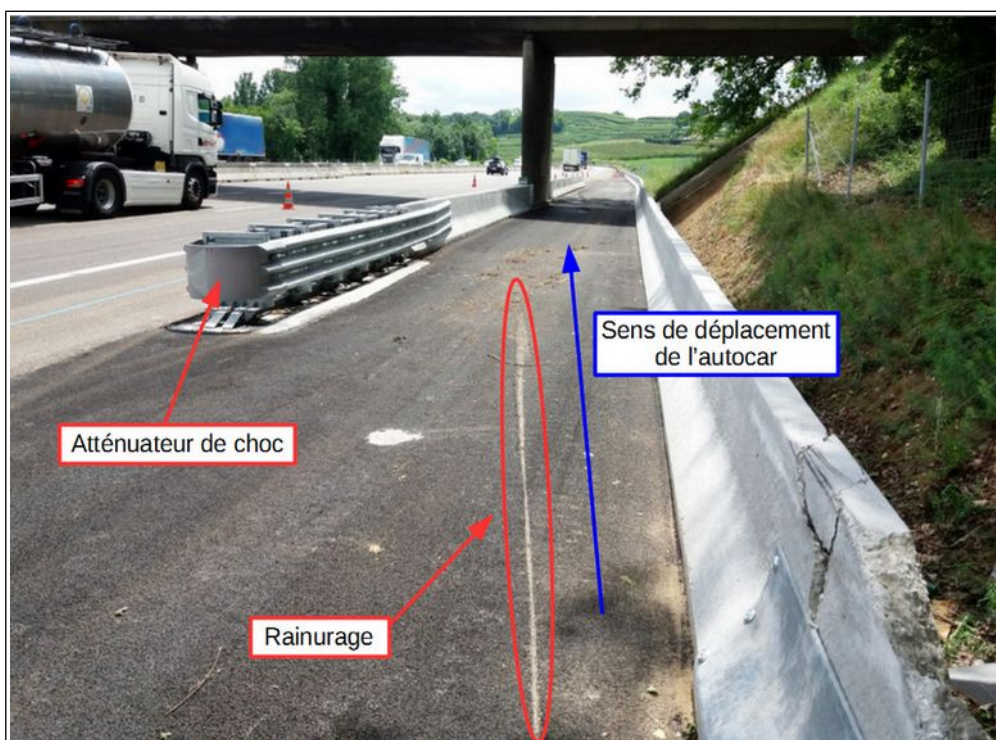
Rainurage de la chaussée après le premier choc de l'autocar contre la GBA
